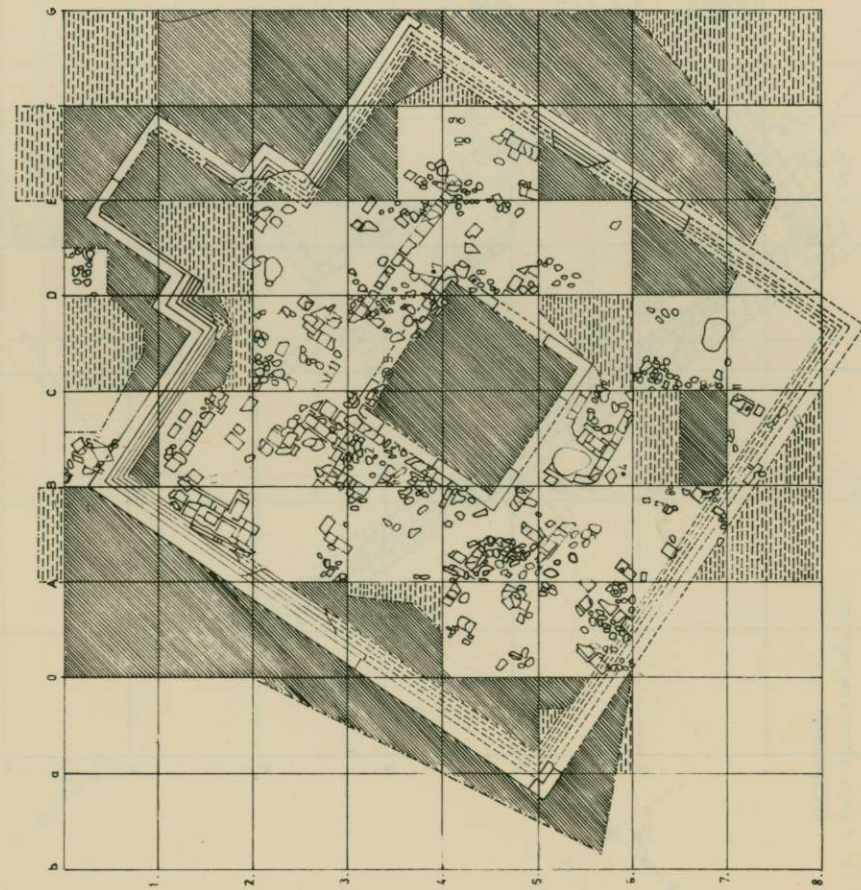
Denah Candi Retno, ekskavasi tahap I
